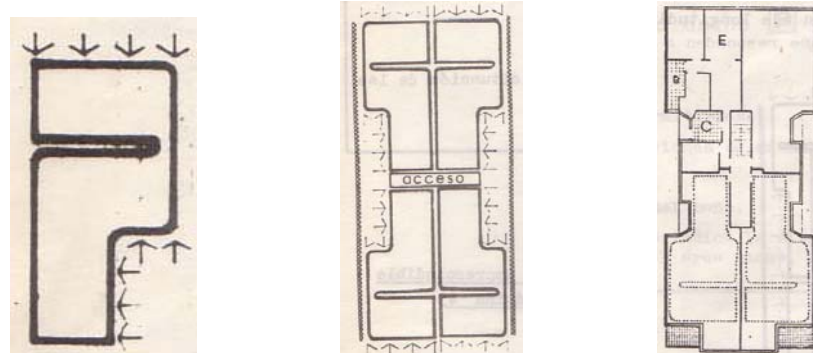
Bloque de viviendas en H (4 viviendas por planta)
